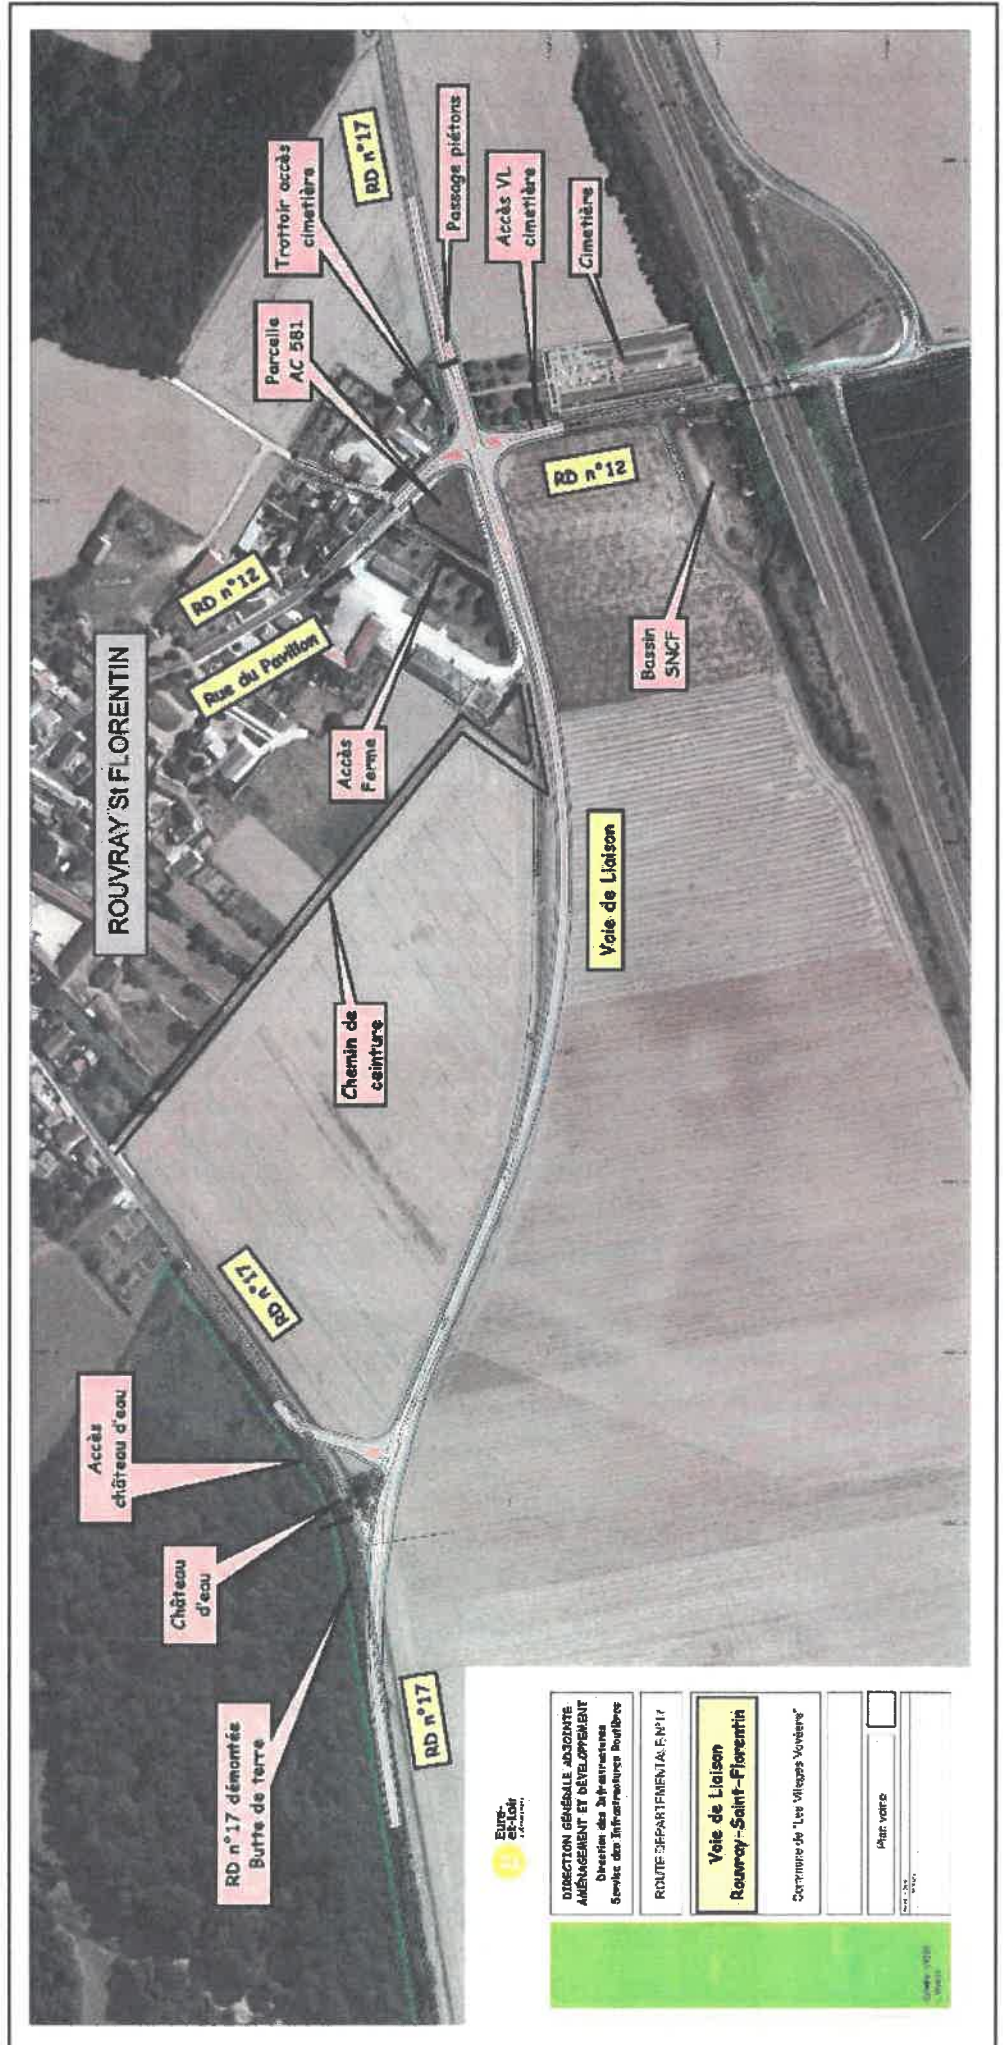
Plan de principe du projet de voie de liaison Sud de Rouvray-Saint-Florentin
